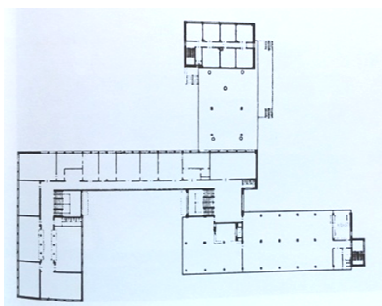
Planta Escuela Bauhaus, Dessau.
